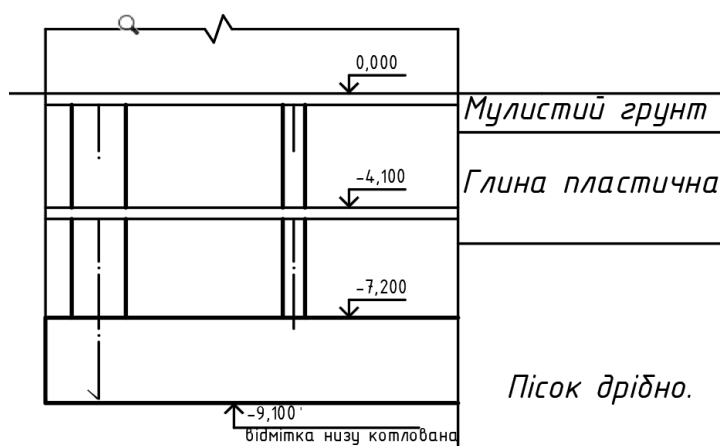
Схема розміщення фундаменту у ґрунті
